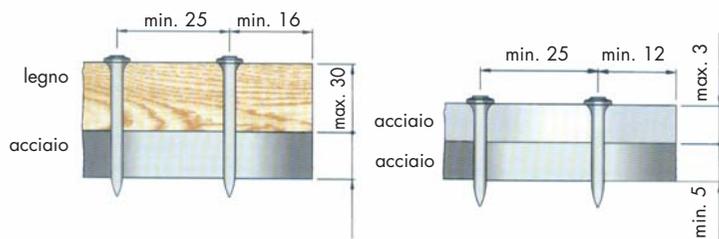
profondità di posa e distanze tra i fissaggi in acciaio (profondità minima di posa 8 mm, interasse minimo 25 mm, distanza dai bordi minima 16 mm, spessore minimo del supporto 5 mm, spessore massimo dell'elemento da fissare (non preforato) 3 mm)
